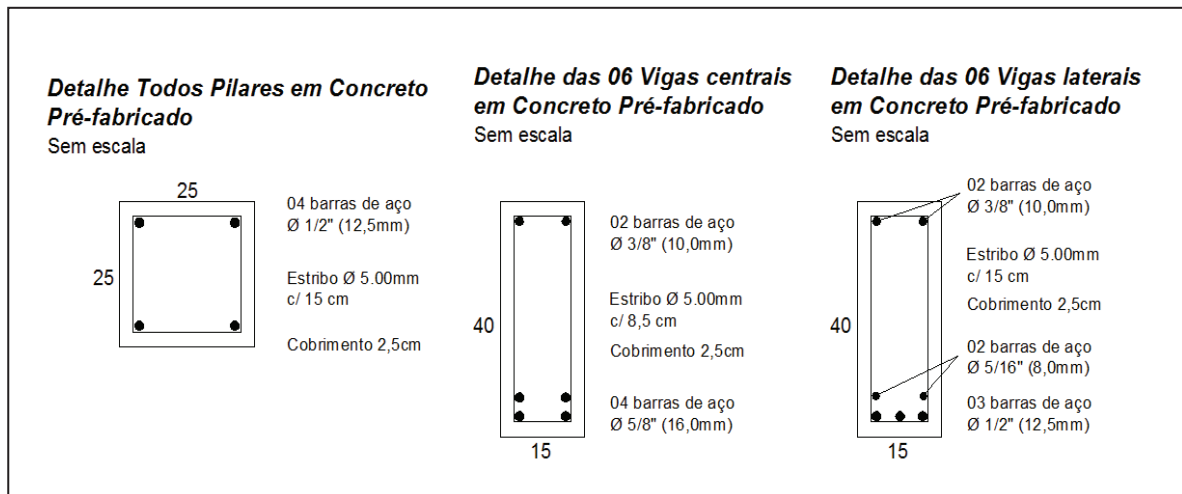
Detalhe seção vigas e pilares- análise dinâmica com tirantes.
